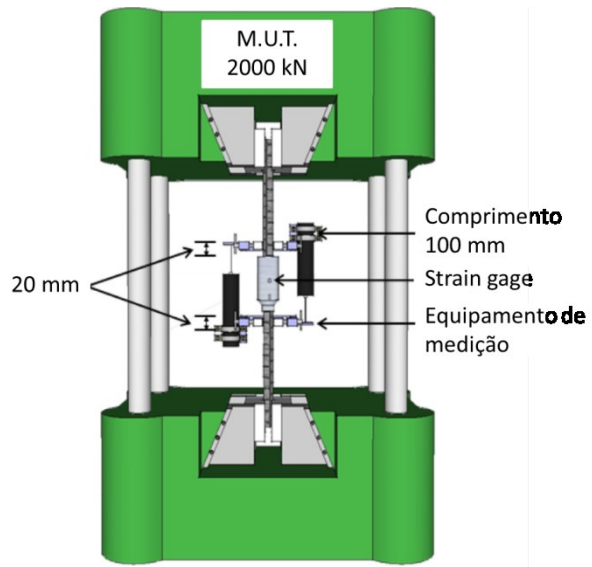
Ilustração proposta da instrumentação da luva de emenda.
